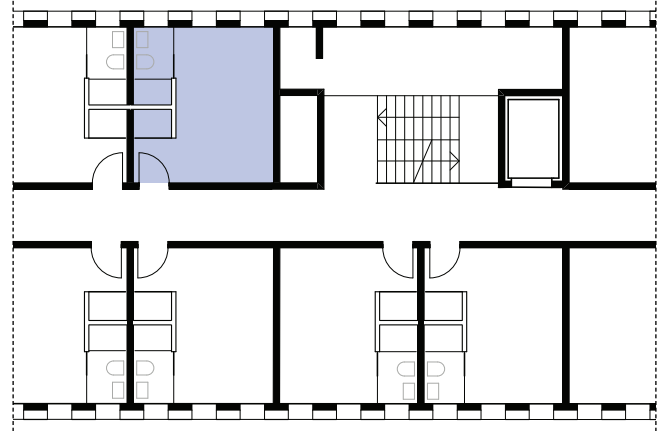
Beispielhafter Grundrissausschnitt des Alpenhotels Ammerwald
